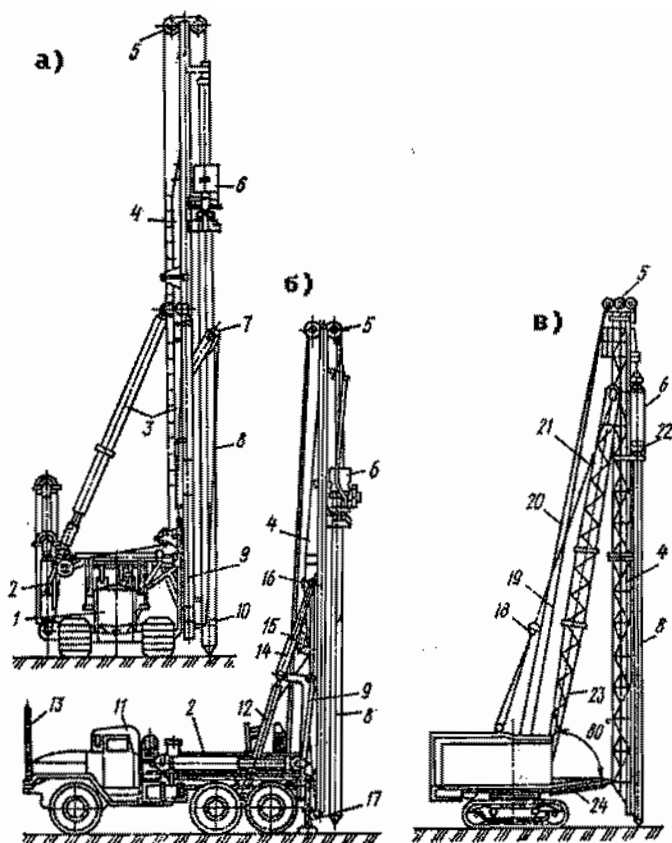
Забивка свай самоходными сваебойными агрегатами: 1 - трактор; 2 - гидроманипулятор для подъема молота и свай; 3 - гидравлические раскосы; 4 - мачта; 5 - головка с блоками; 6 - молот; 7 - стрела заводки свай под молот; 8 - свая; 9 - рама; 10 - нижний отводной блок; 11 - автомобиль; 12 - гидроцилиндры подъема молота и свай; 13 - опоры мачты (для транспортного положения); 14, 15, 16 - гидроцилиндры наклона мачты, выдвижения стрелы и перемещения мачты; 17 - выносные опоры; 18 - полиспаст; 19 - канат молота; 20 - свайный канат; 21 - стреловой канат; 22 - наголовник; 23 - стрела экскаватора; 24 - телескопическая распорка
